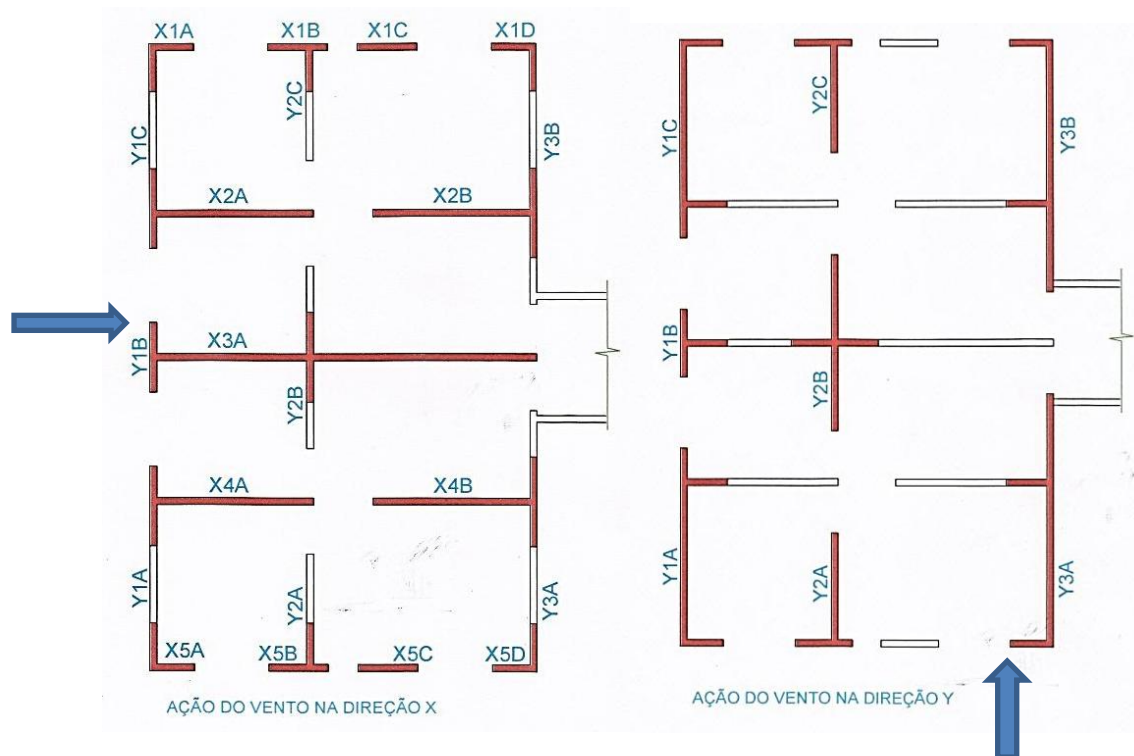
Ação do vento no pavimento tipo nas direções X e Y
